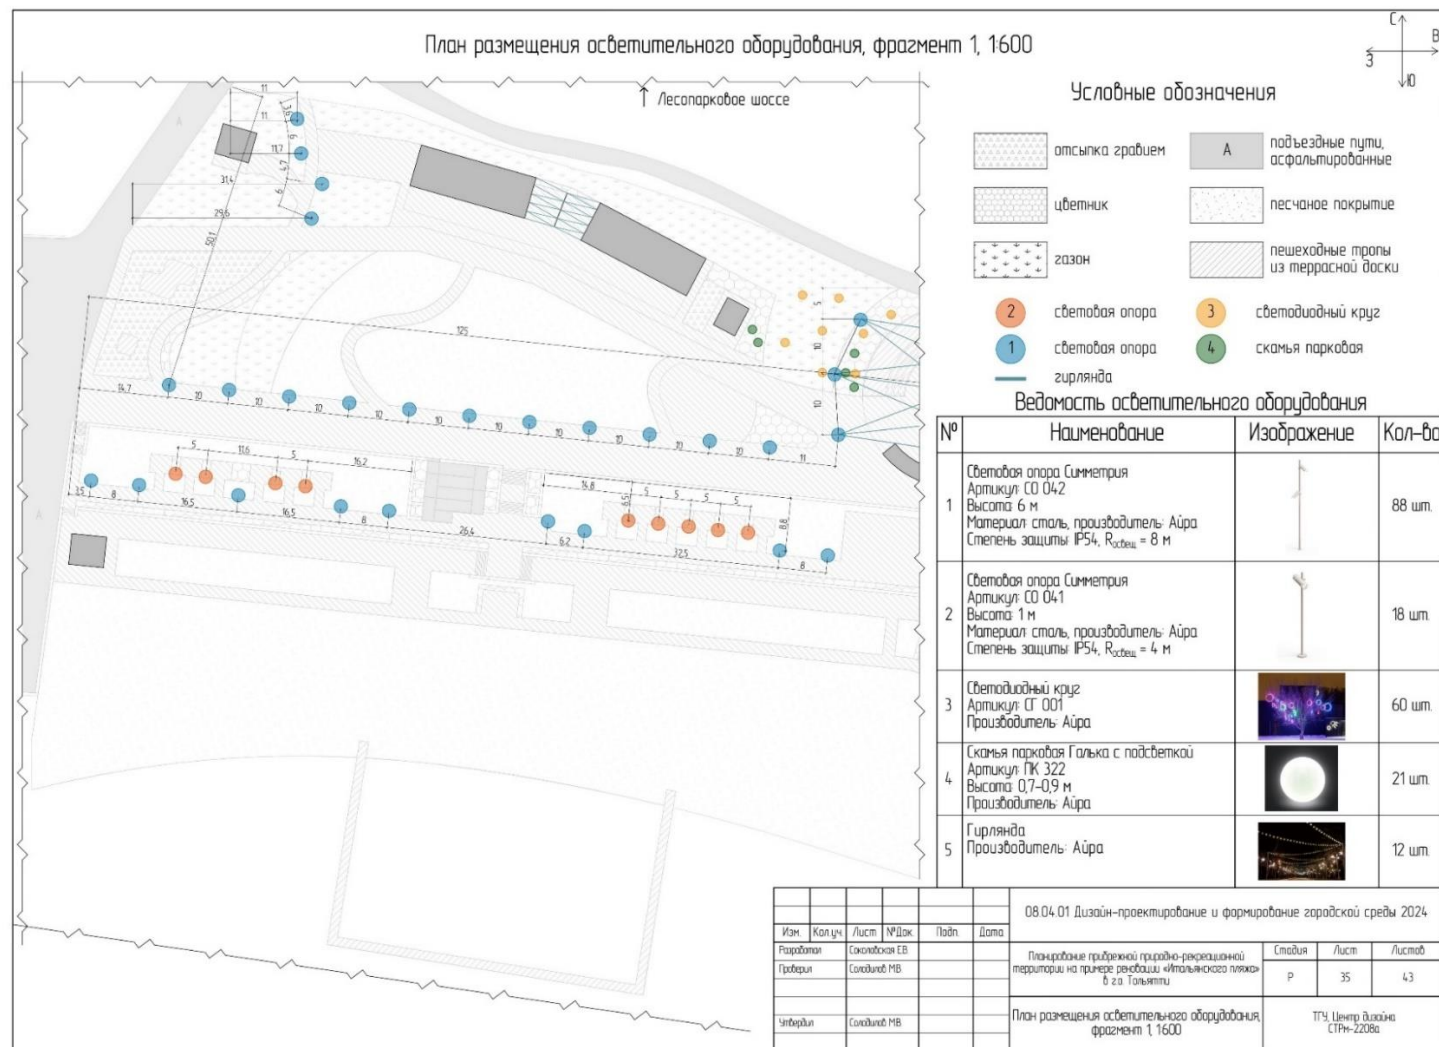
План размещения осветительного оборудования, фрагмент 1
